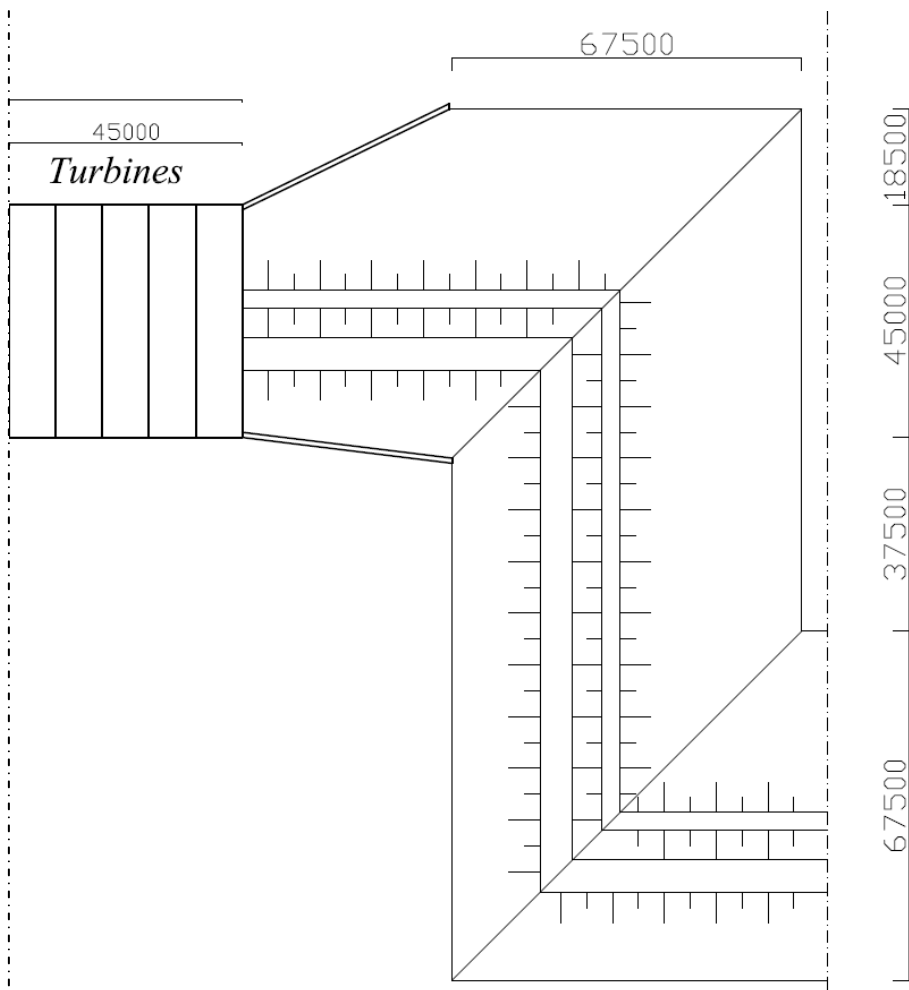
; Doorsneden aanstroomconstructie bij turbines en sluizen
